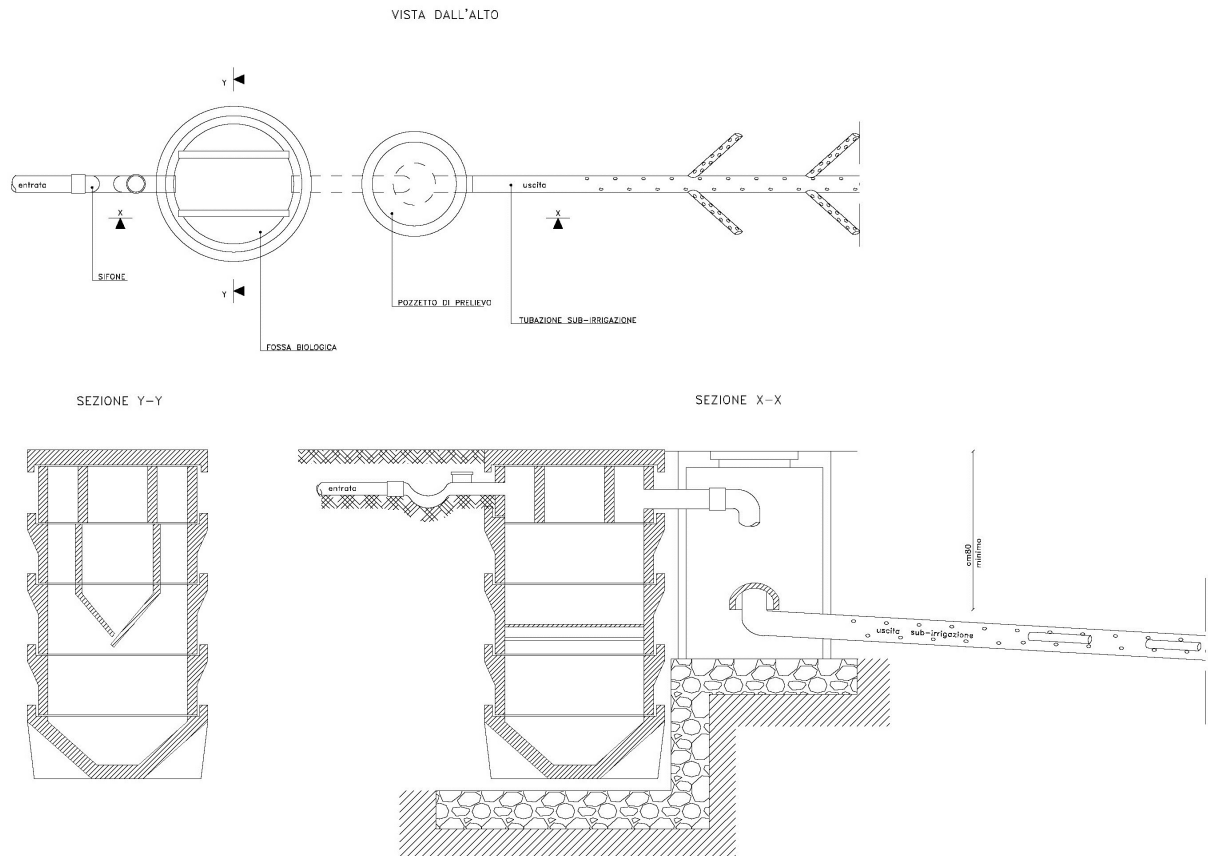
Schema di trattamento con sub-irrigazione.
